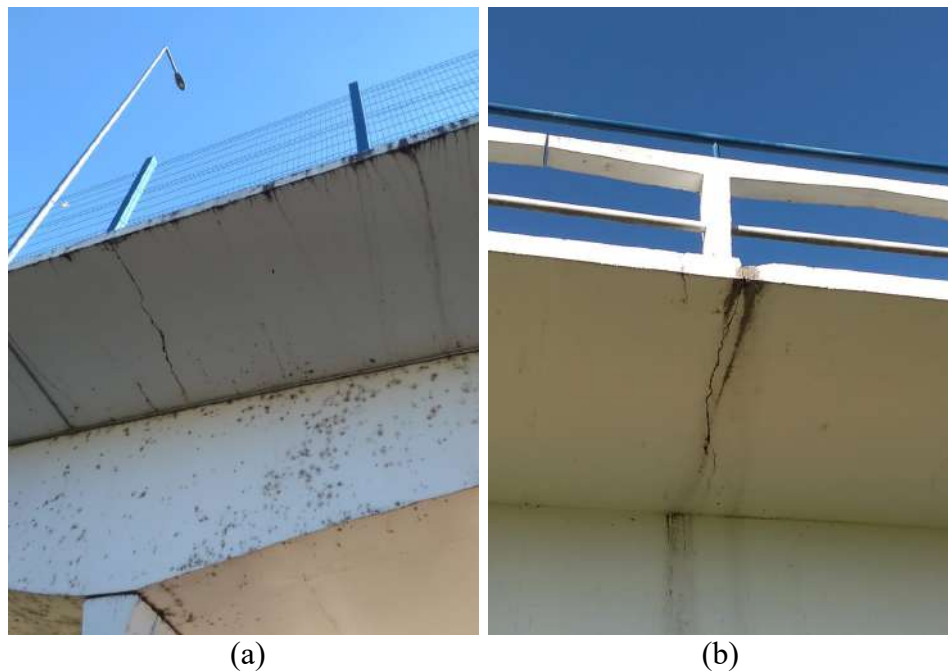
Fissuras transversais ao eixo da ponte localizadas nas lajes de passeio: (a) laje à esquerda da pista; (b) laje à direita da pista.
